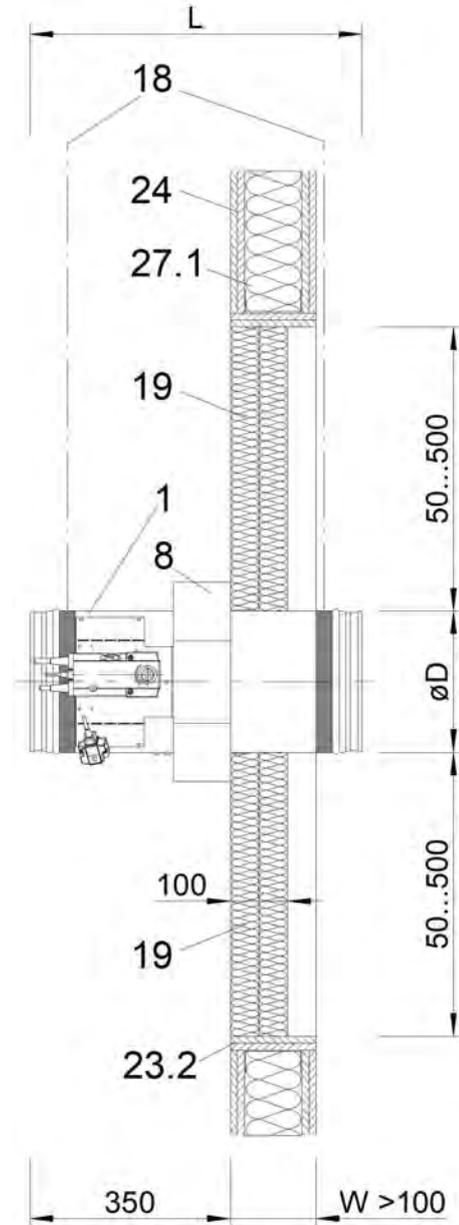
Einbau in Metallständerwand (Wanddicke > 100 mm)
